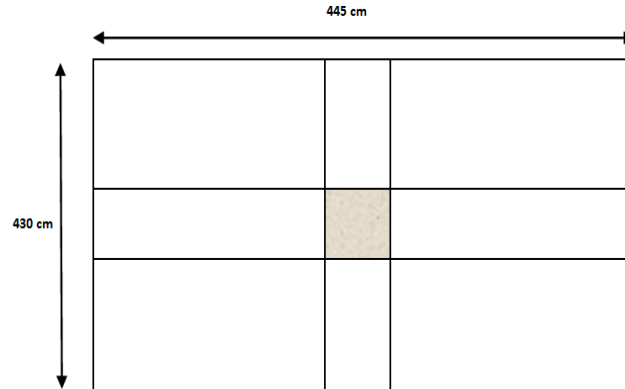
Représentation de la surface du poteau le plus sollicité
